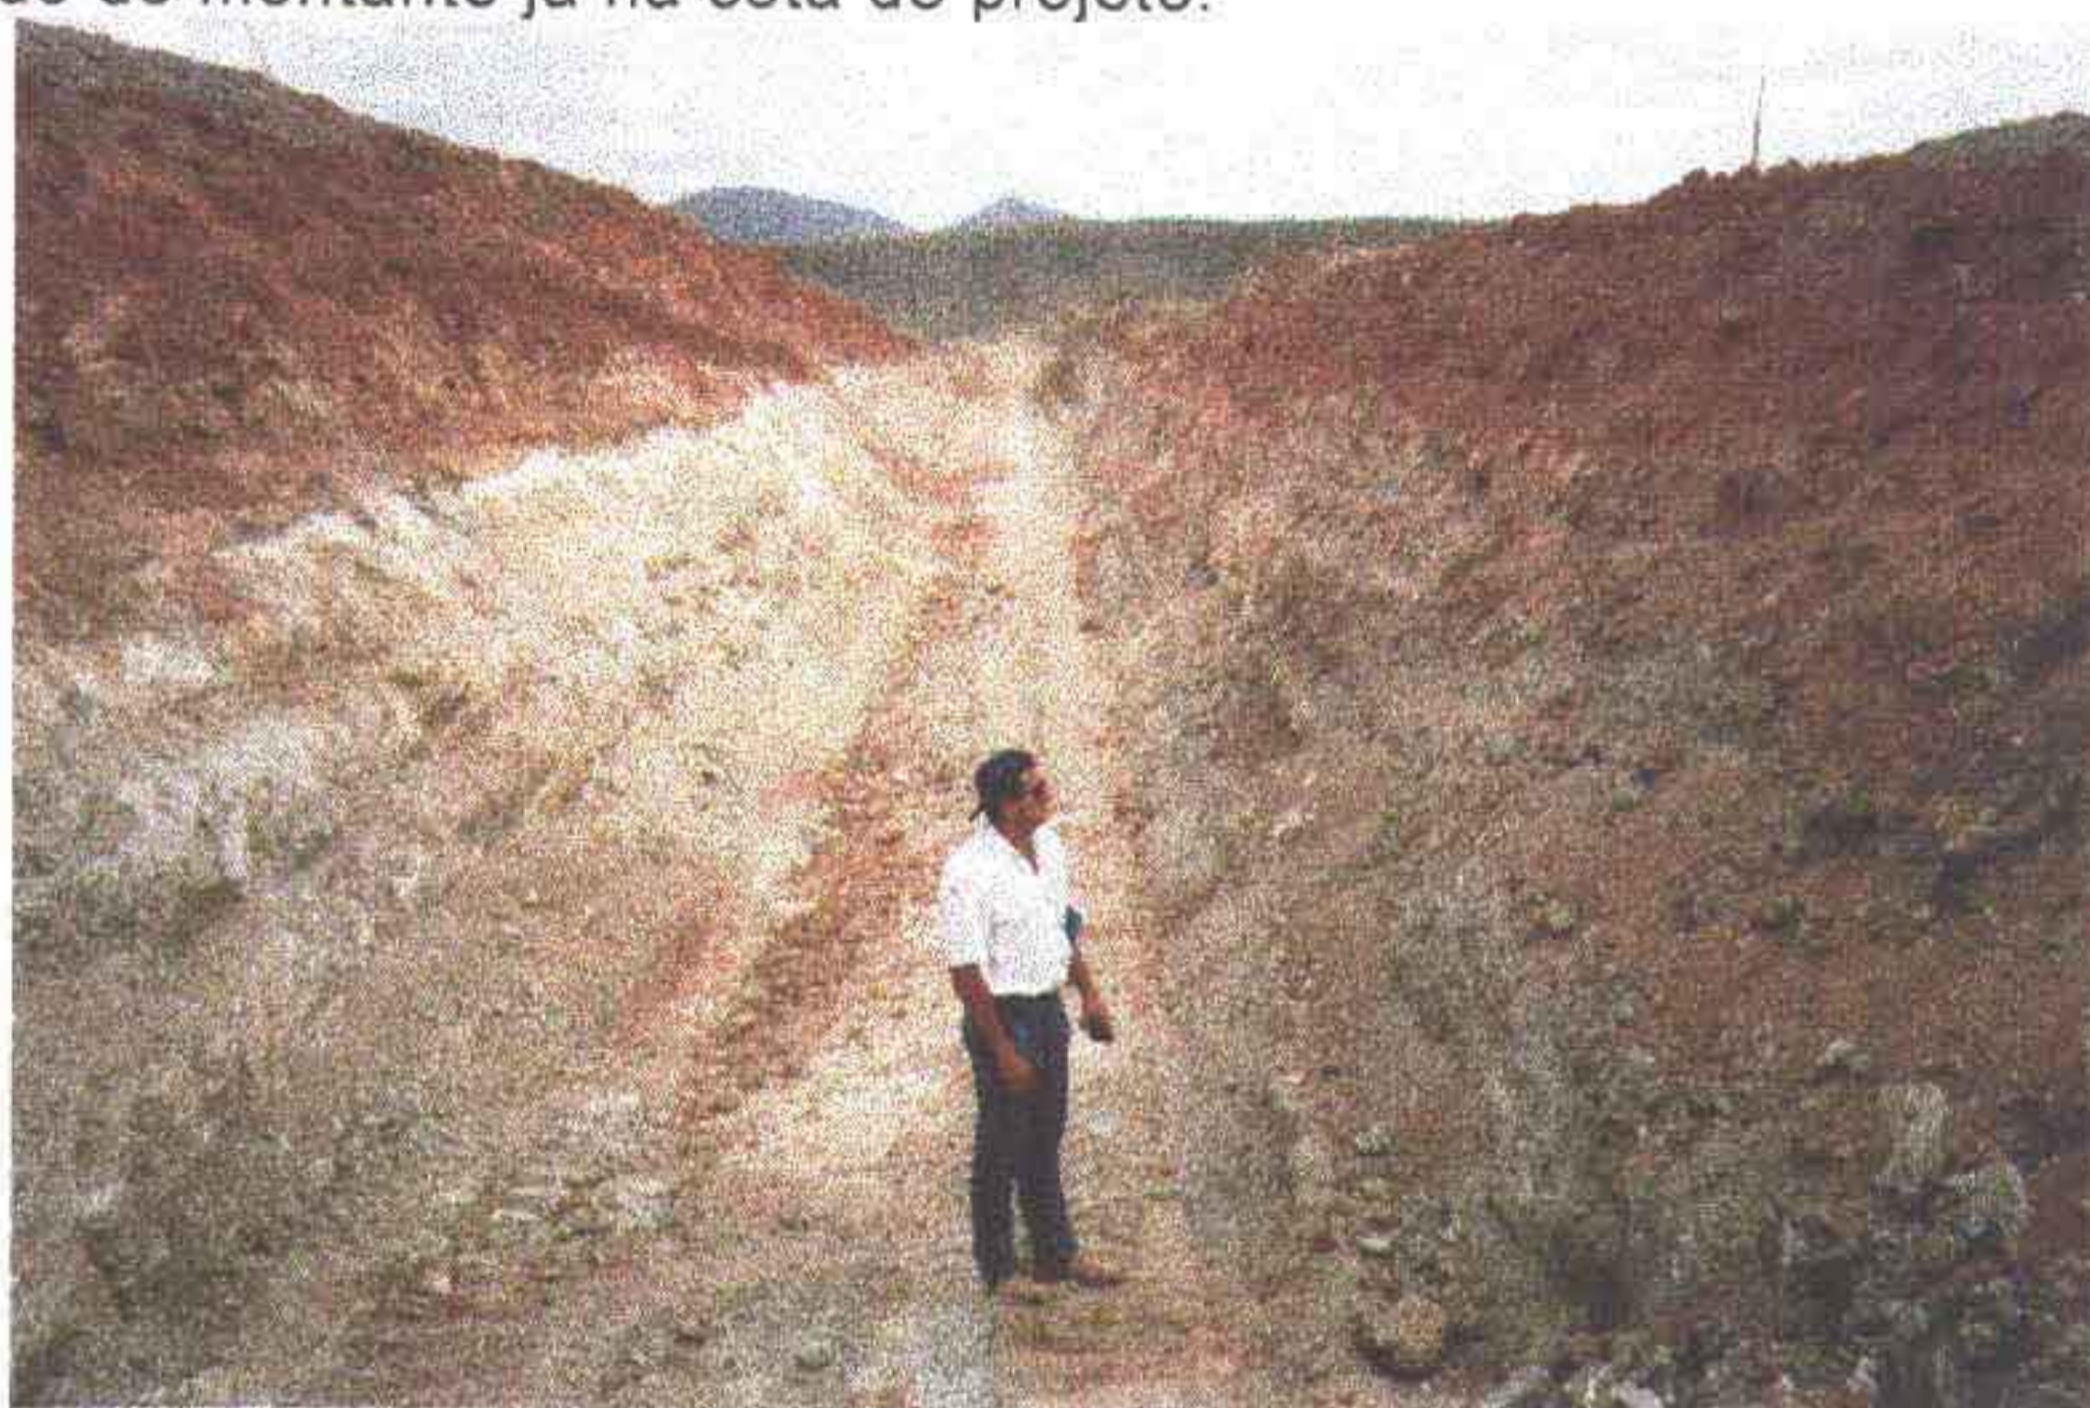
Escavação da fundação da galeria. Vista do montante para jusante onde observa-se o perfil geológico. Bem definida a separação entre material de 1ª categoria e de 2ª categoria. Já atingida a cota do projeto restando apenas a limpeza fina.
